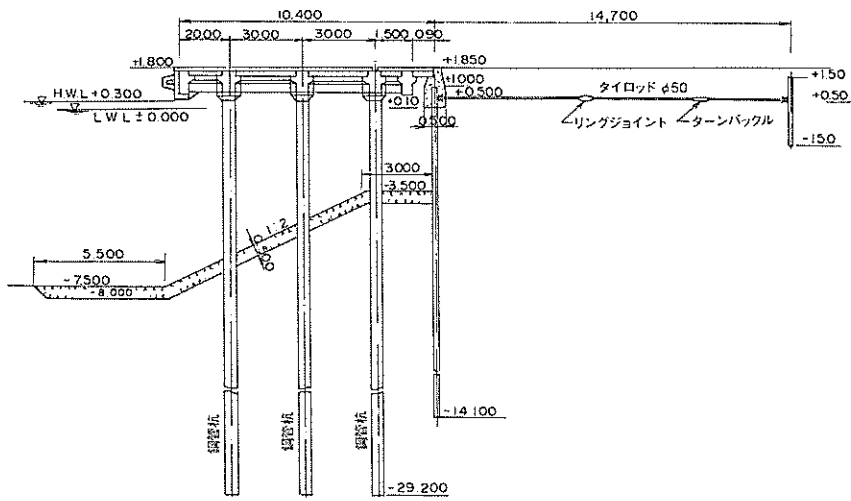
外港昭和北2号岸壁⑯ 標準断面図
